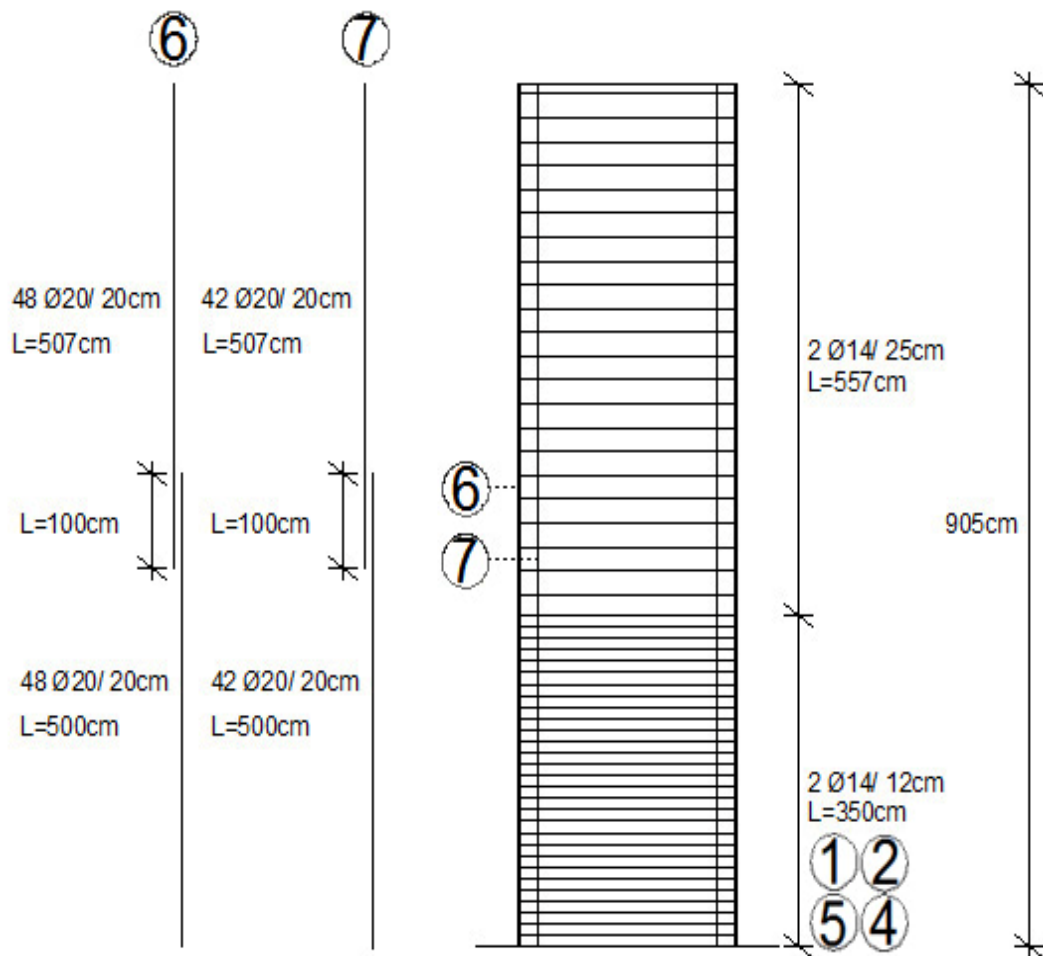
Armatura longitudinale pila 4. Configurazione a pile bloccate.
